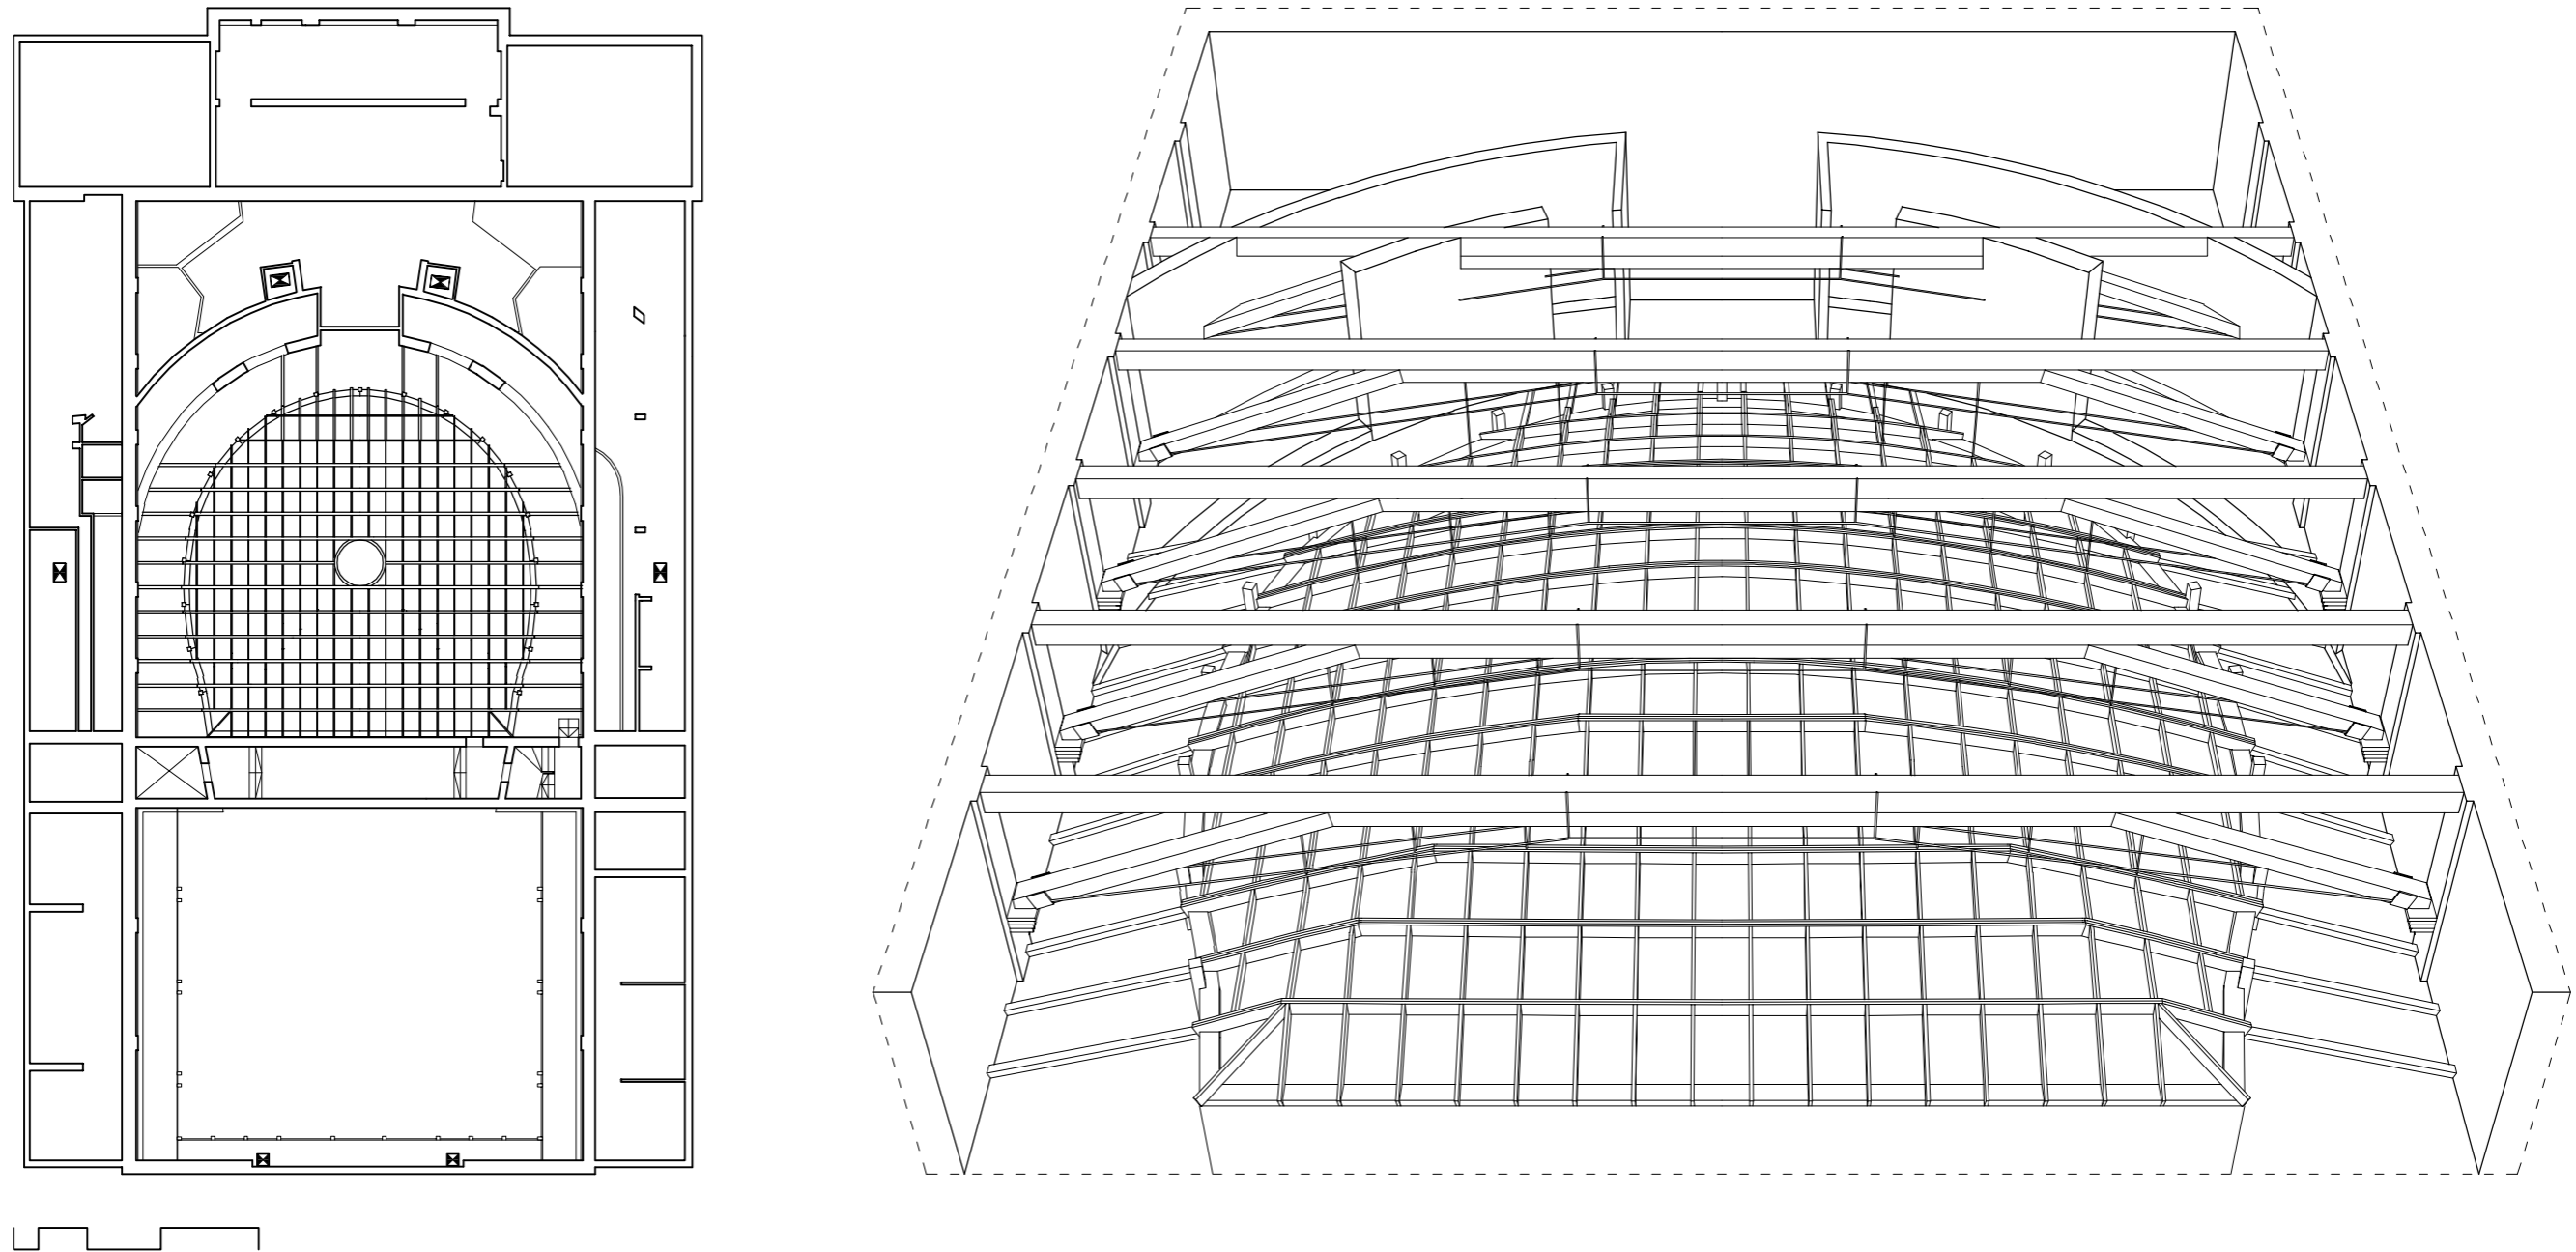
Teatro Comunale di Carpi. Pianta del piano sottotetto (ridisegno); rappresentazione prospettica del sistema di copertura della sala.
